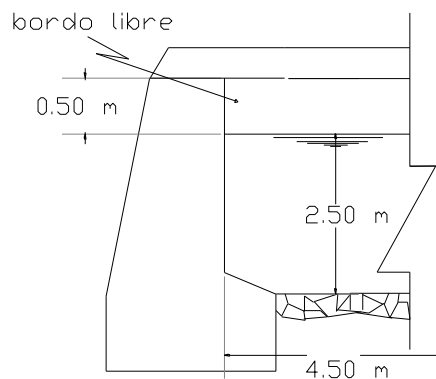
Área de la sección de la alcantarilla 1.
